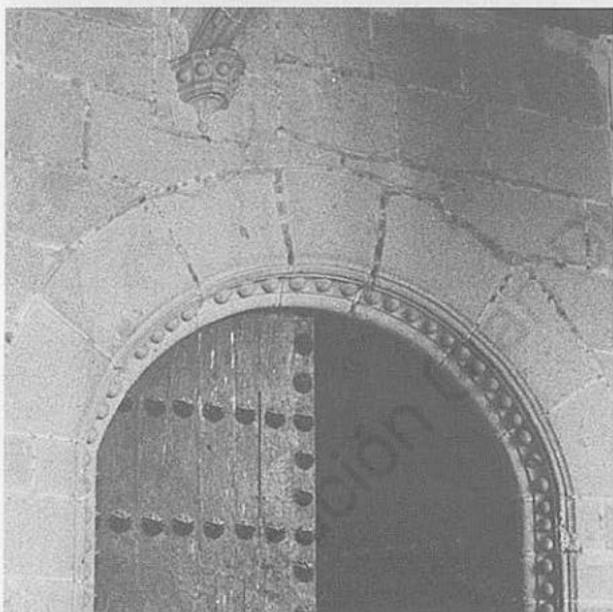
Claustro de los Reyes. Panda este. Corredor inferior. Puerta nº 1, donde se observa el detalle de la ménsula.
